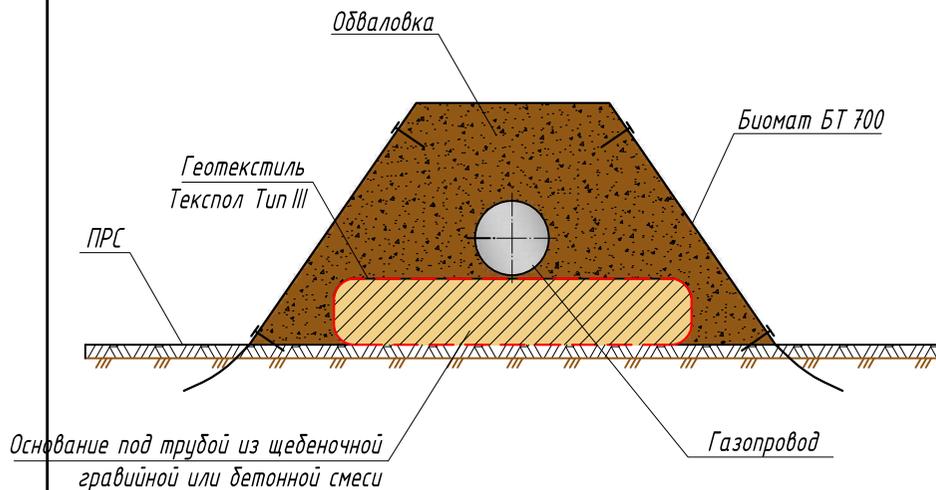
Защита биоматами грунтов обваловок газопроводов наземной прокладки, не армированных геотекстильными материалами
